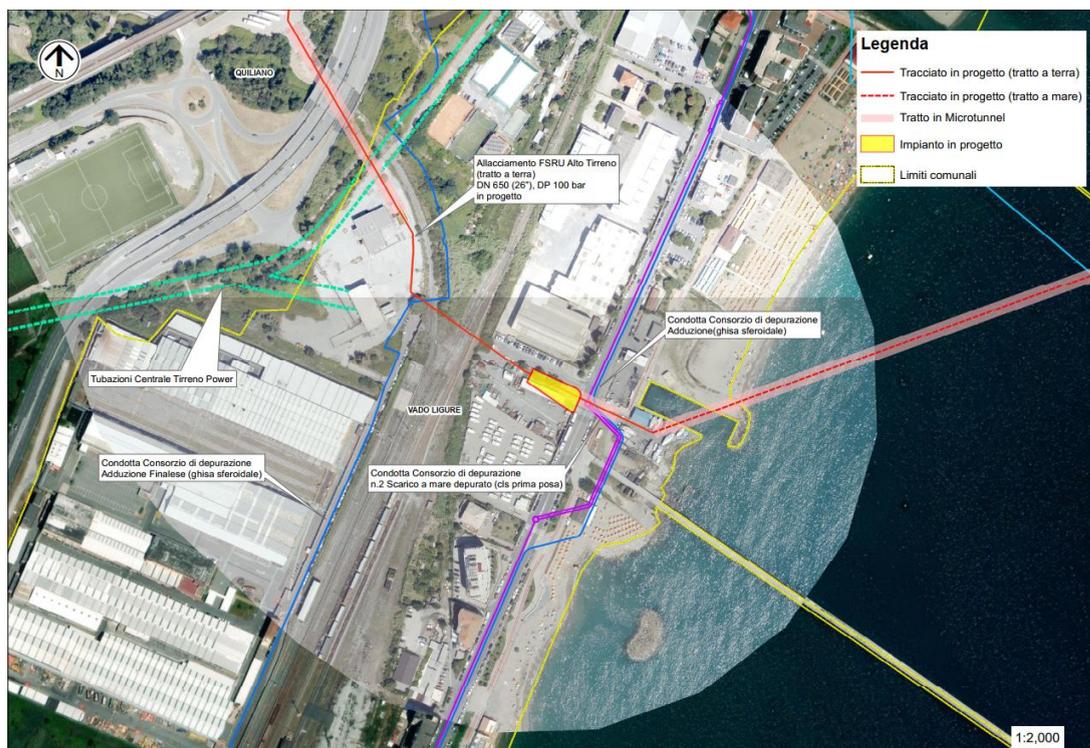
Stralcio planimetrico dall'ortofoto dell'allegato 3
